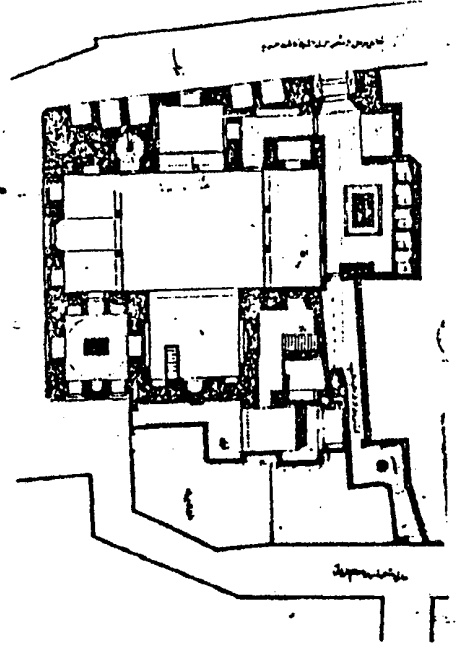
مكرر) مسقط أفقي لمسجد آل ملك الجوكندار بالقاهرة (عن : Creswell)
